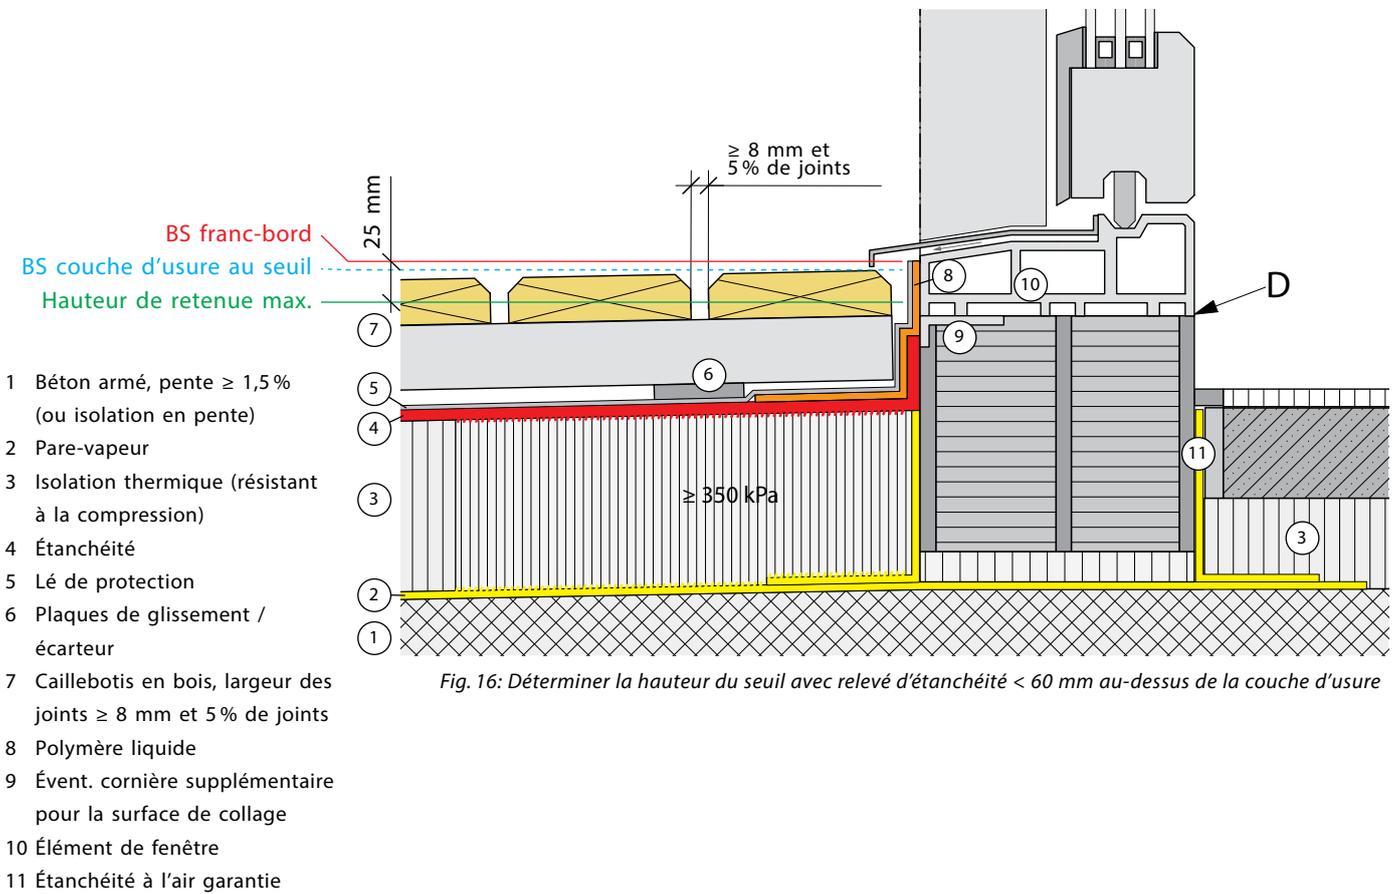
Déterminer la hauteur du seuil avec relevé d'étanchéité &lt; 60 mm au-dessus de la couche d'usure
